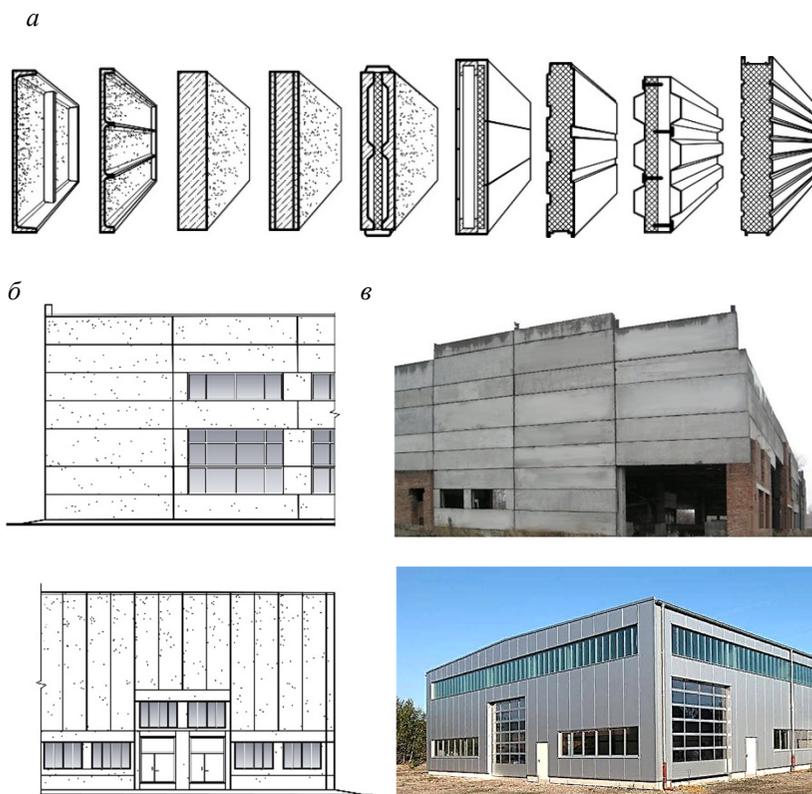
Стены промышленных зданий: *a* — типы панелей: железобетонная ребристая, одно-, двух-, трехслойная (железобетонная, сэндвич-панель); *б* — разрезка стен: горизонтальная, вертикальная; *в* — примеры разрезки на фасадах
